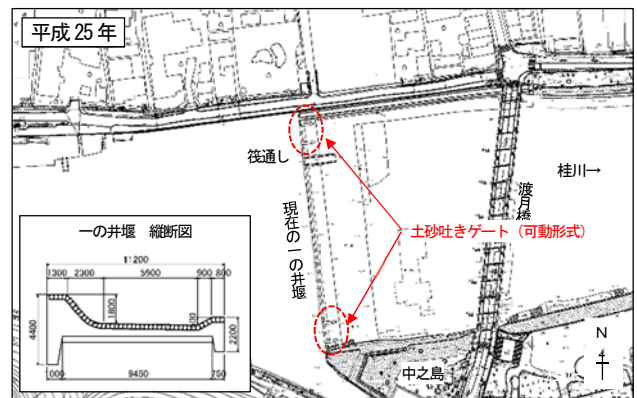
現在の平面図と一の井堰の縦断面図¹⁵⁾に加筆
